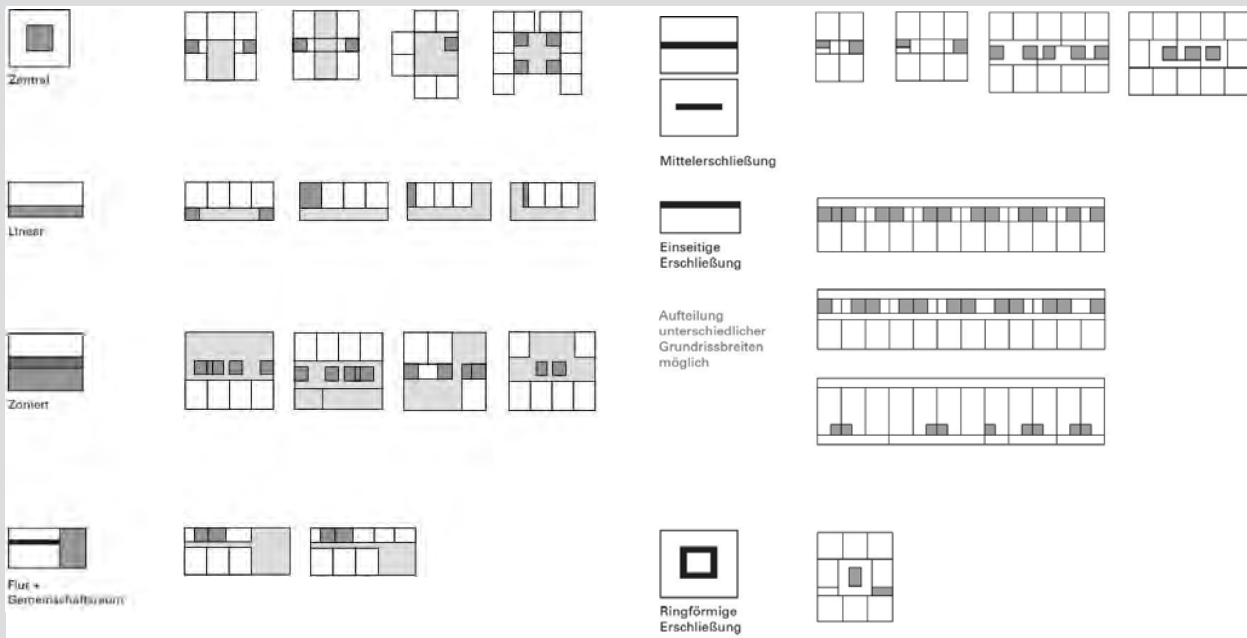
Funktionale Flexibilität: Grundrisstypen mit nutzungsneutralen Räumen
